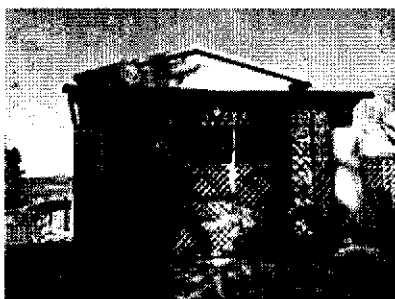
(edificio 10649) FOTO n° 50056 (edificio 10649) FOTO n° 2328 (edificio 10649)
